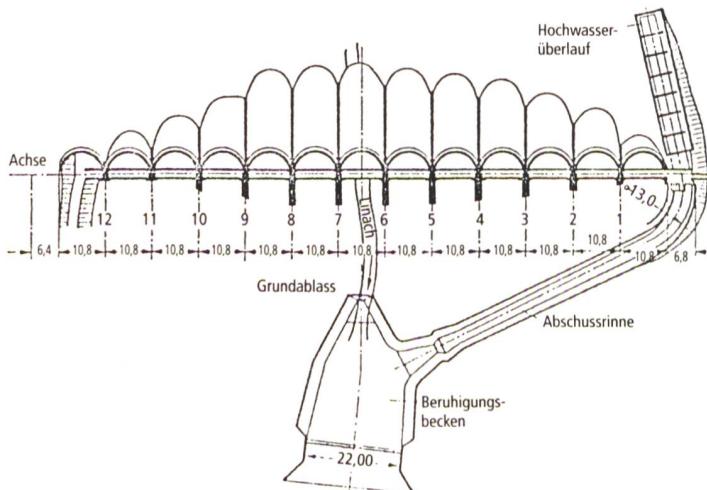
Grundriss der Staumauer mit Hochwasserüberlauf.
